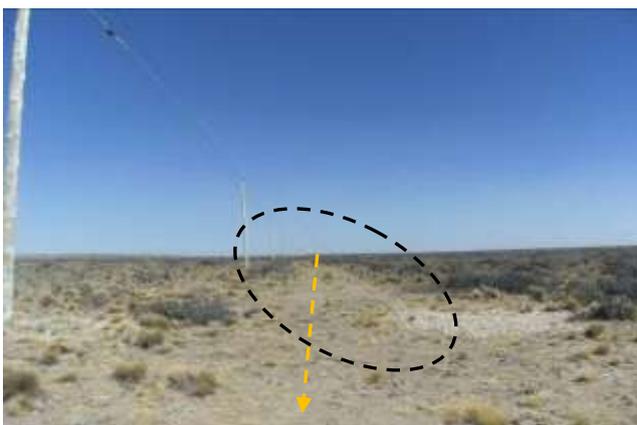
Emplazamiento de oleoducto por picada (revegetada). Cruce con anclaje de tendido eléctrico (negro). Foto en dirección SO.
